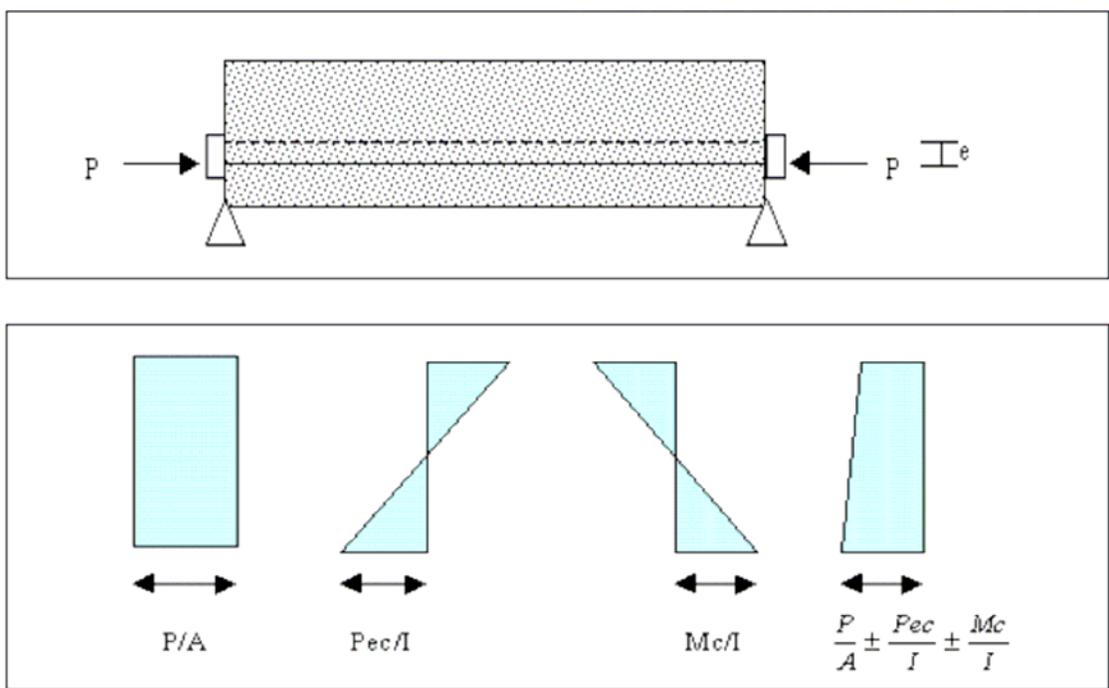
En las caras de los bloques en contacto existe un coeficiente de fricción, por lo que el pretensado crea la resistencia al corte en la viga. Esta resistencia al corte es la que impide el desplazamiento de un bloque respecto del otro en la dirección de la carga aplicada, en ese sentido el pretensado además de limitar las tensiones de tracción del elemento crea además una resistencia adicional al corte. La acción del pretensado es más eficiente cuando el cable es colocado excéntricamente con respecto al centroide de la sección, en este caso la excentricidad “e”, es la distancia del centroide al punto de colocación del cable.
